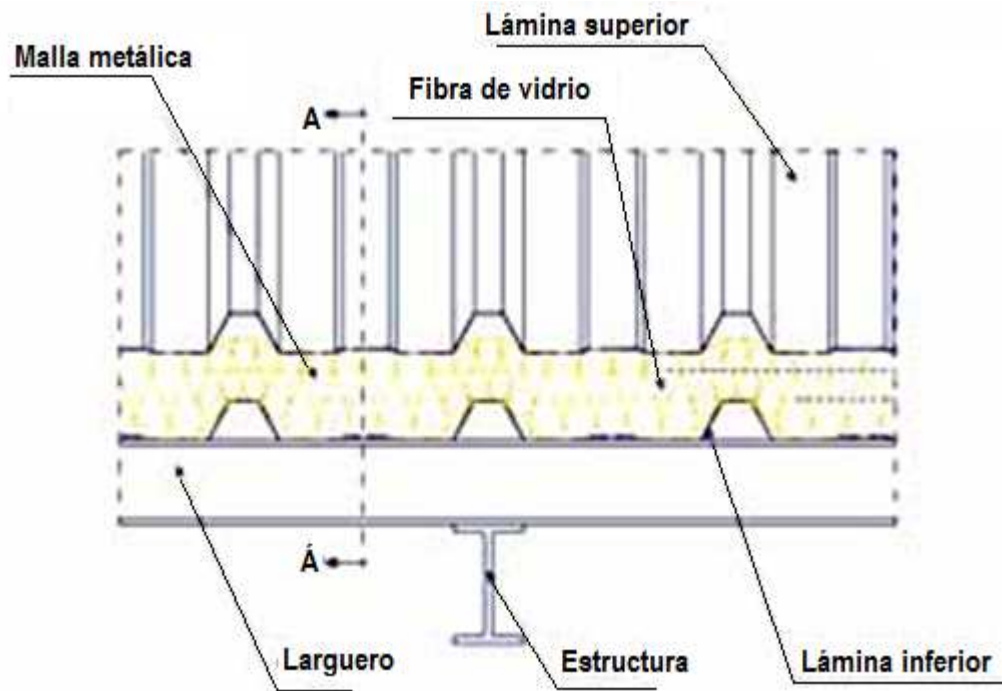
Detalle constructivo de un panel sándwich “in situ”.
